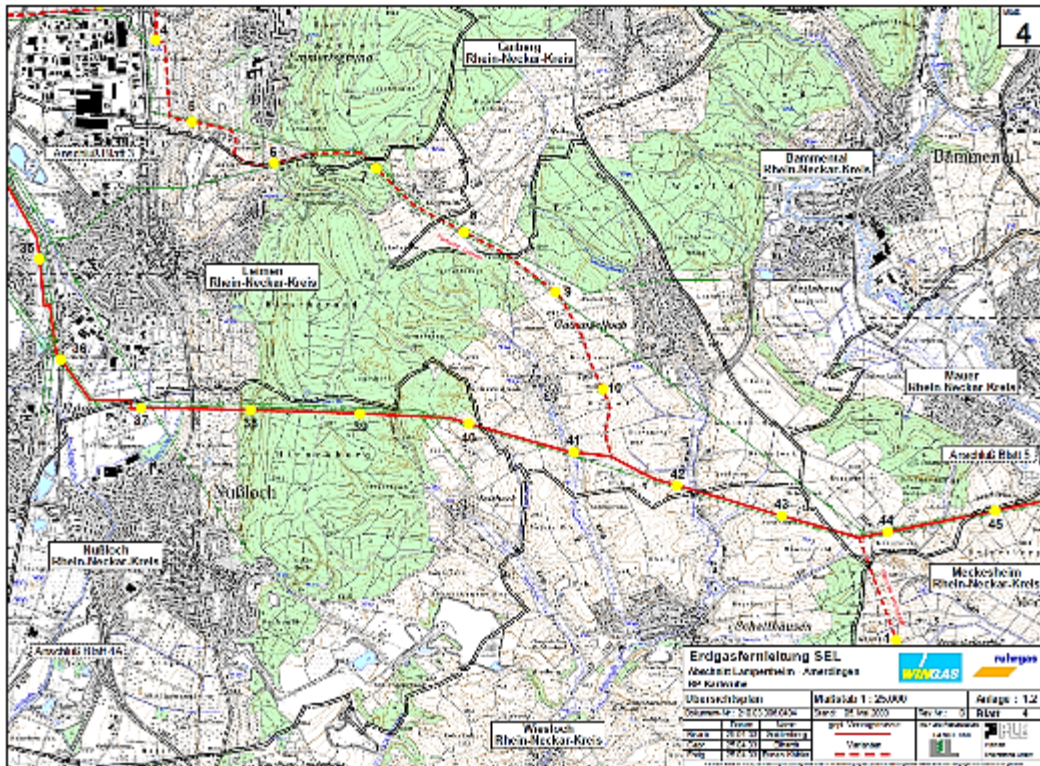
Lageplan Nußloch – Blatt 2; Die 2006 planfestgestellte Trasse wird hier in der ROV-Unterlage noch als gestrichelte Variante dargestellt. (Quelle: ROV)
